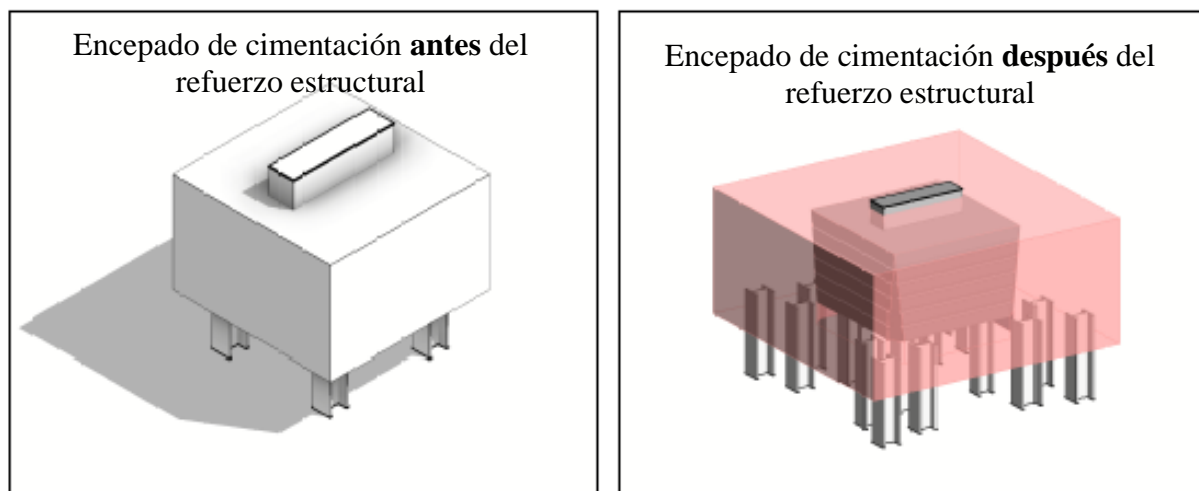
Detalle genérico en perspectiva (antes y después) del refuerzo estructural de los encepados de cimentación.
